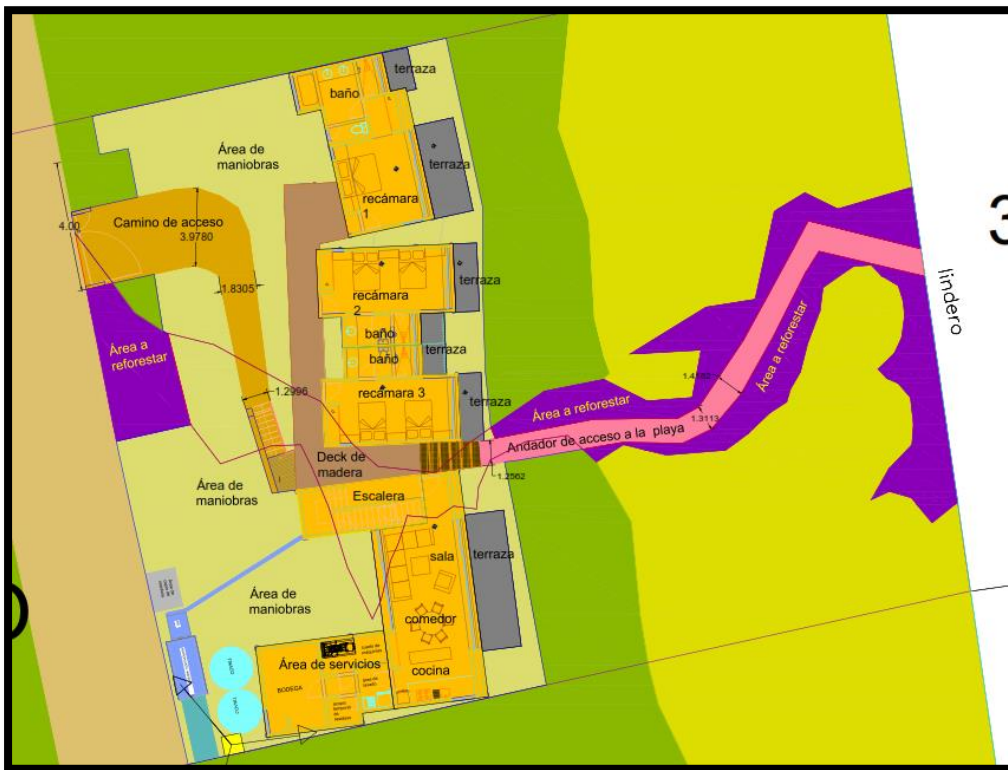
Plano de obras techadas y sin techar del proyecto (ver plano 2 en anexo planos).
